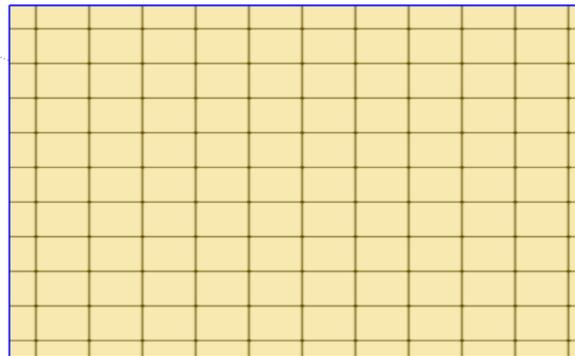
Rencana Plafon Kantor BLK lantai 2
